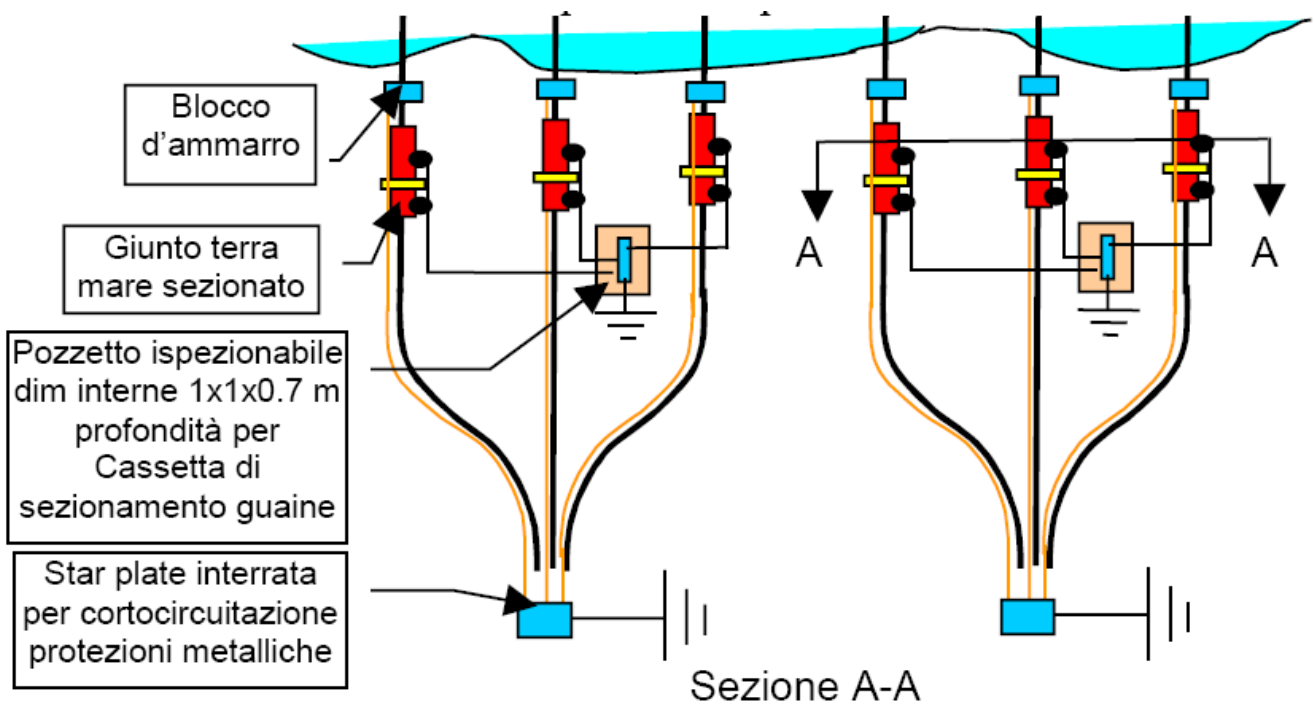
Schema tipico della cameretta di giunzione tra cavo marino e cavo terrestre
